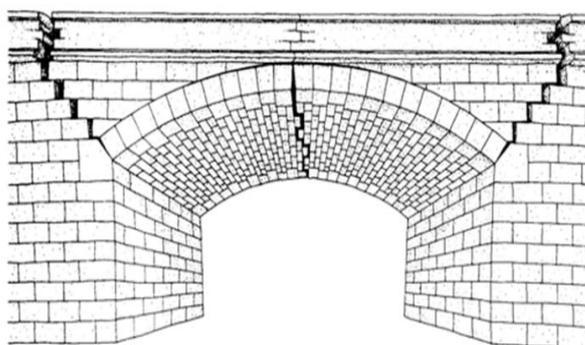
FIS-11 Descripción: Fisuración transversal del intradós en la clave y del trasdós en los arranques.
